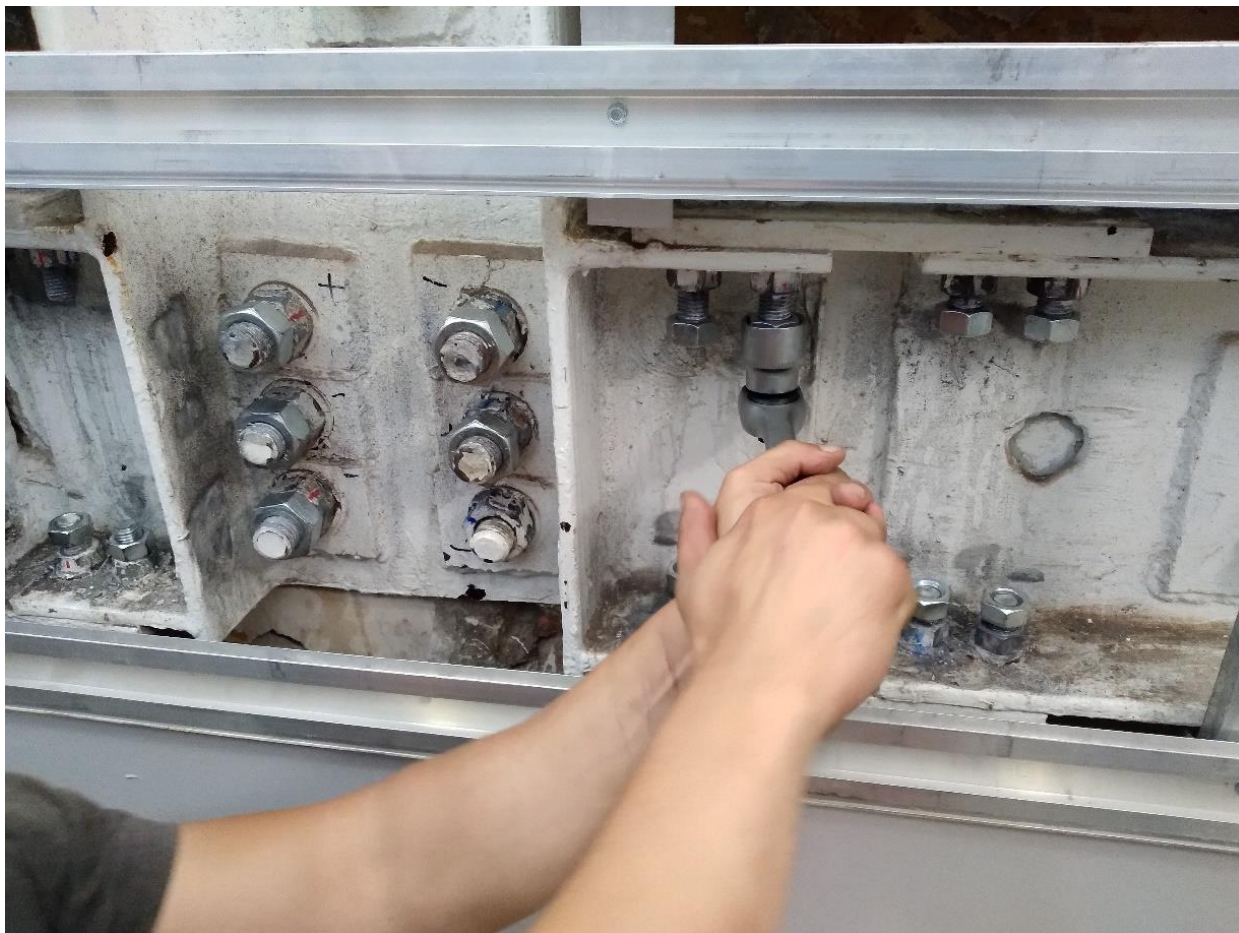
Sprężanie połączeń elementów konstrukcji.
